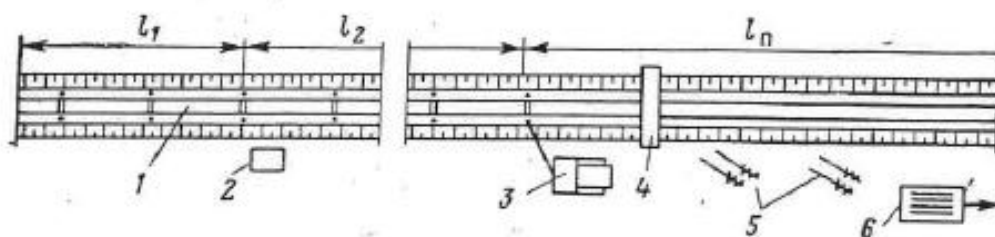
Технологическая схема закрепления трубопровода анкерами
